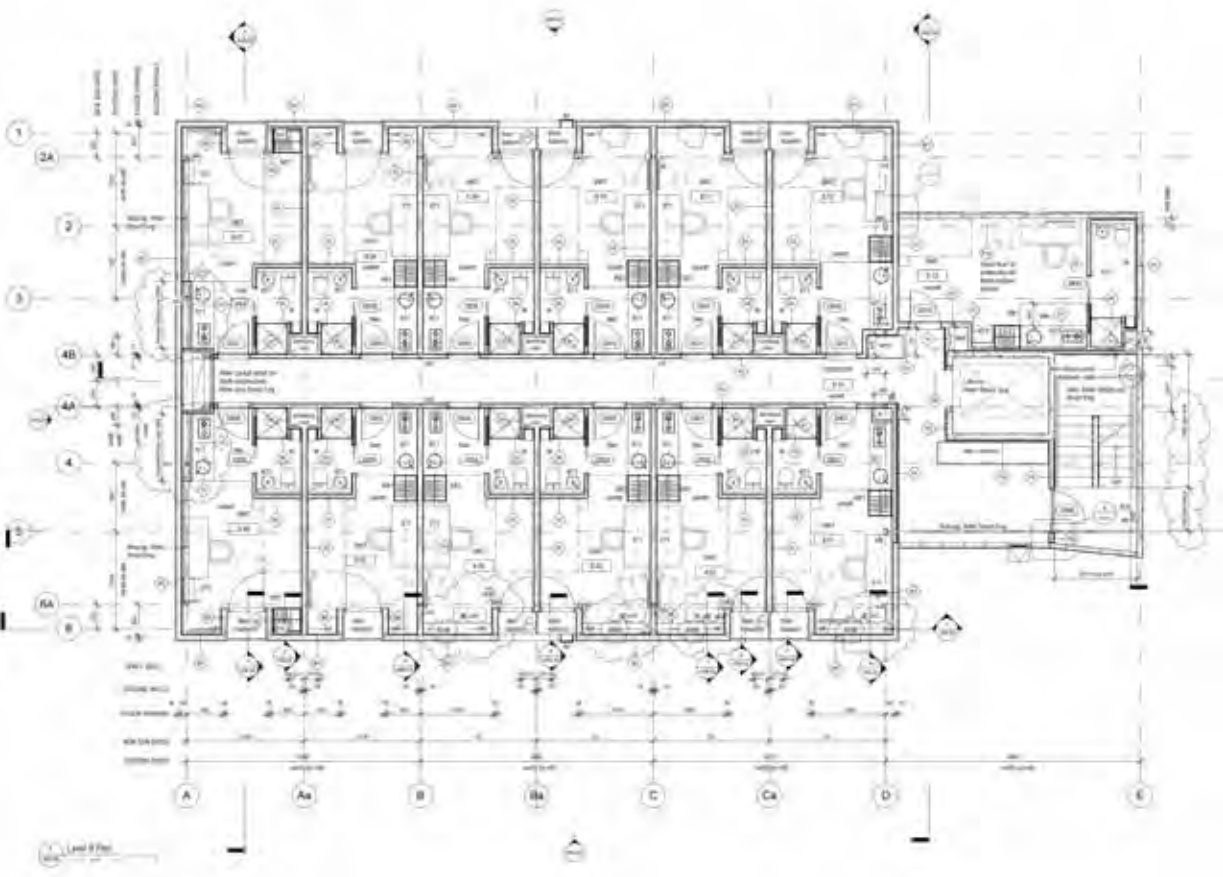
Grundriss 8.OG © Hayball Architects
